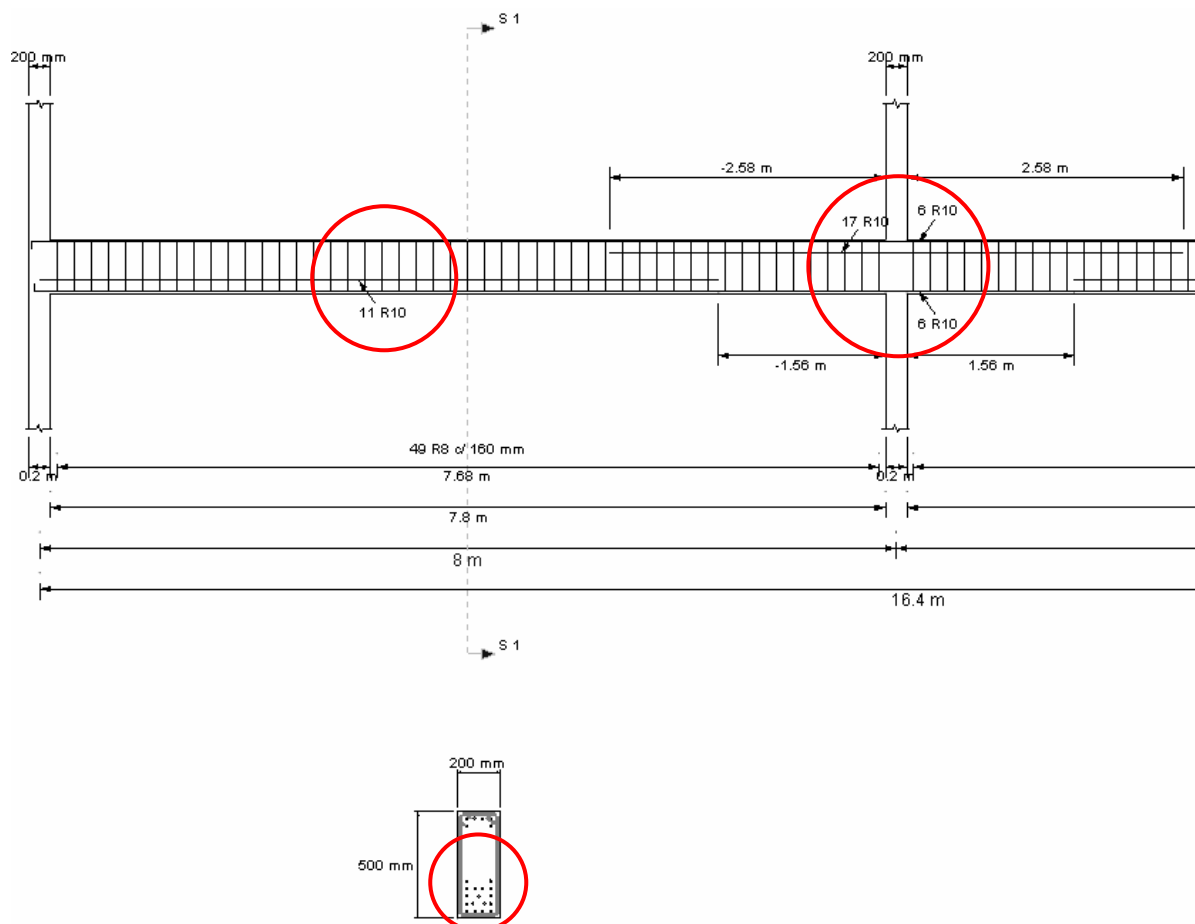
Armado automático de una viga de hormigón con ejecución poco viable sin una adecuada intervención del usuario
